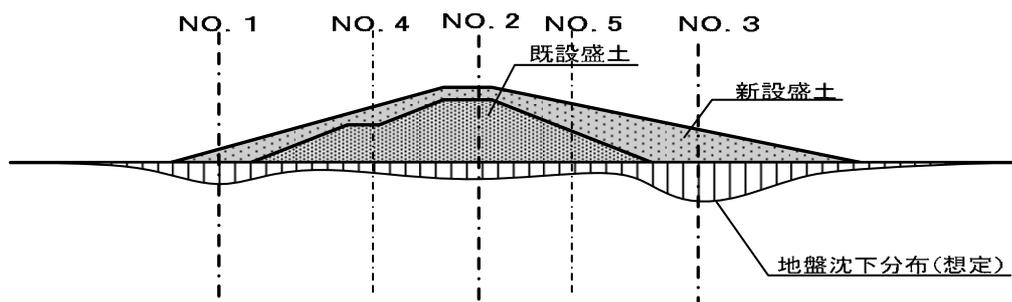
サウンディング調査・ボーリング調査位置の計画例 (1)
